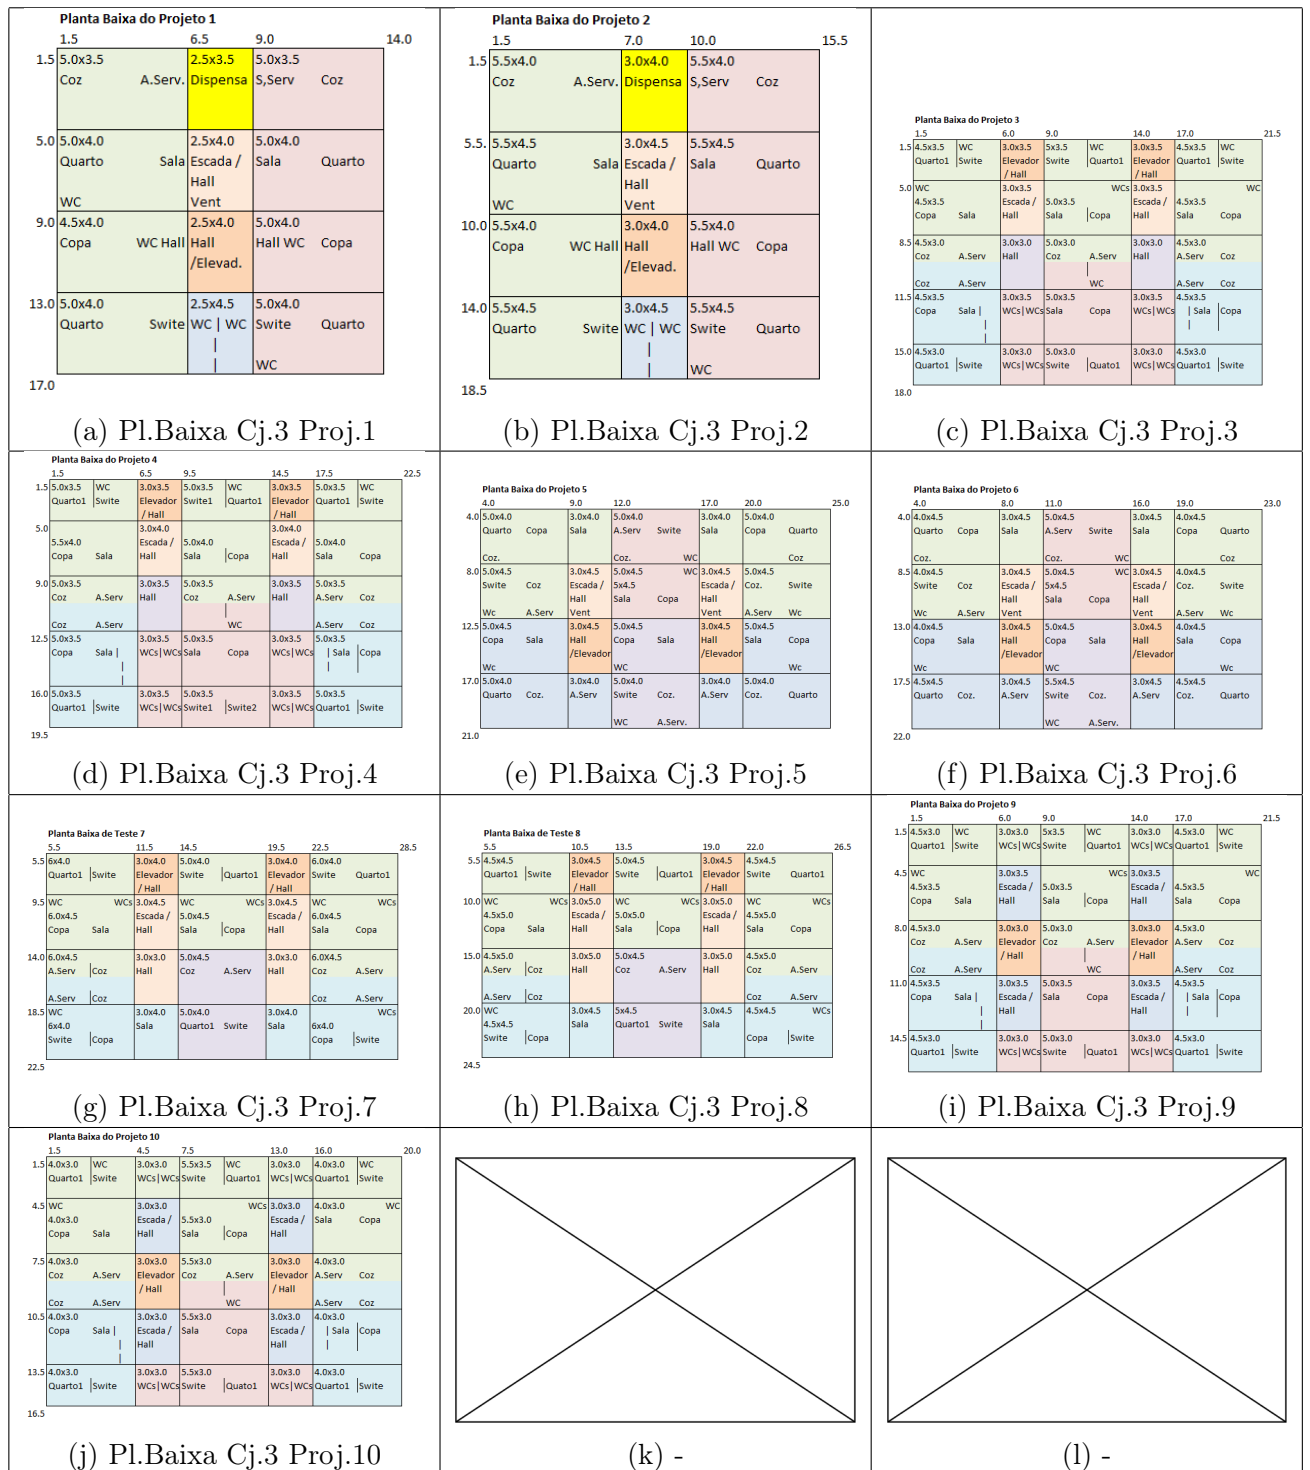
Plantas Baixas - Cj.3 - Pjs.Treino 1 a 7 - Teste 8 a 10
